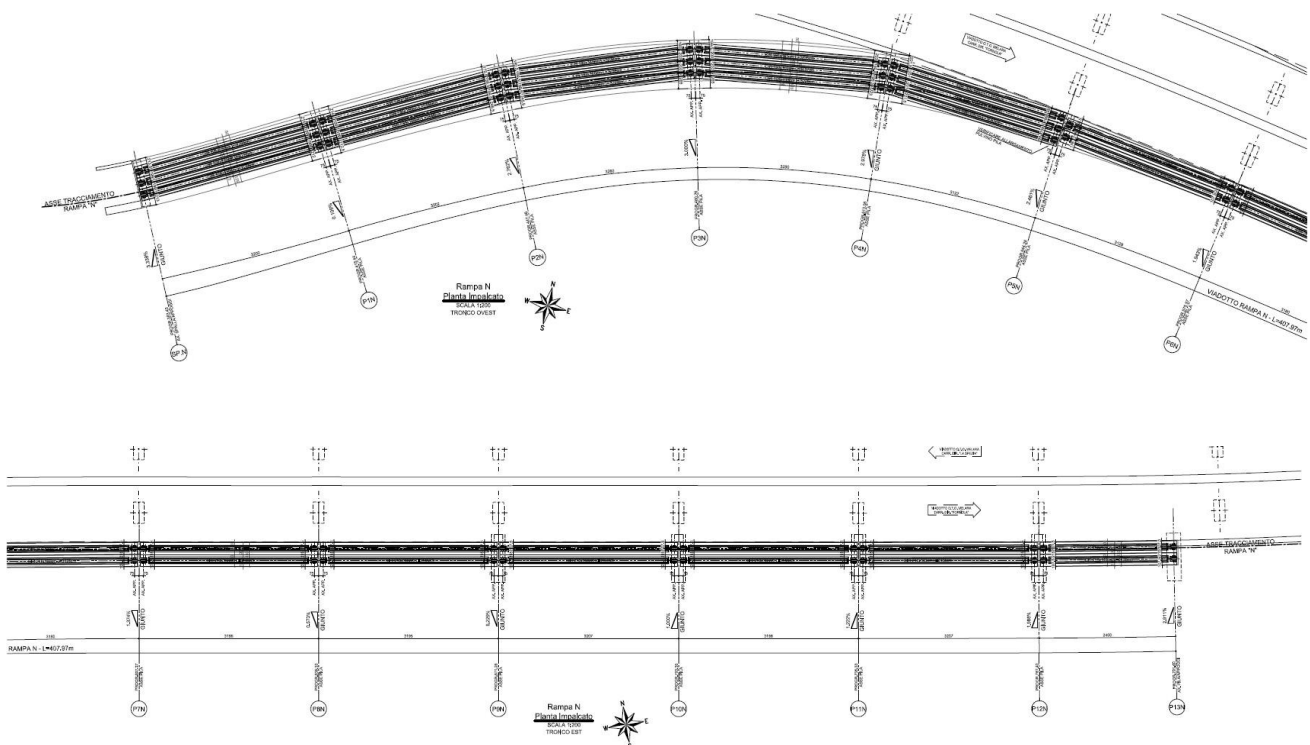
Planimetria Rampa N svincolo Melara
